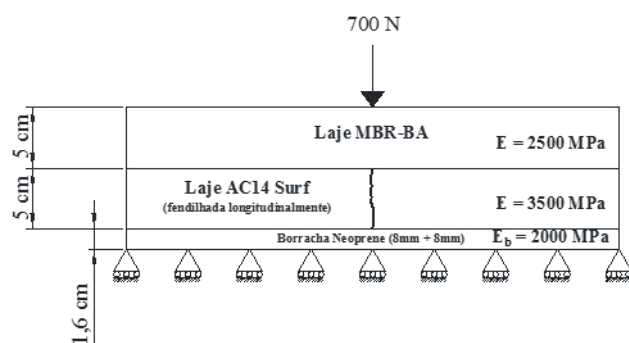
Suporte das lajes modeladas (membranas neoprene)
